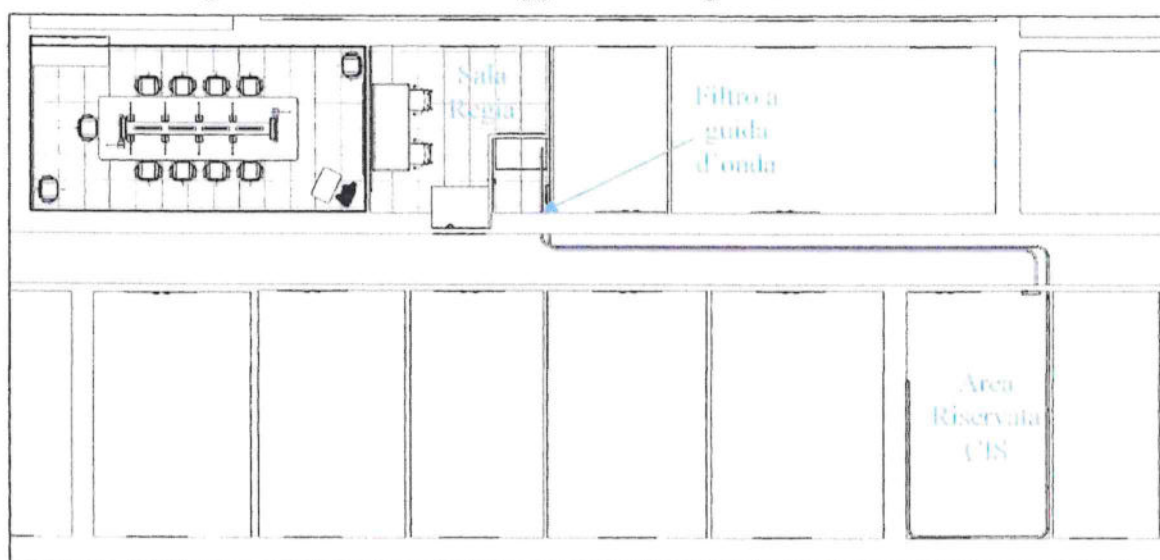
, Planimetria – Passaggio da Sala Regia a Area Riservata CIS
